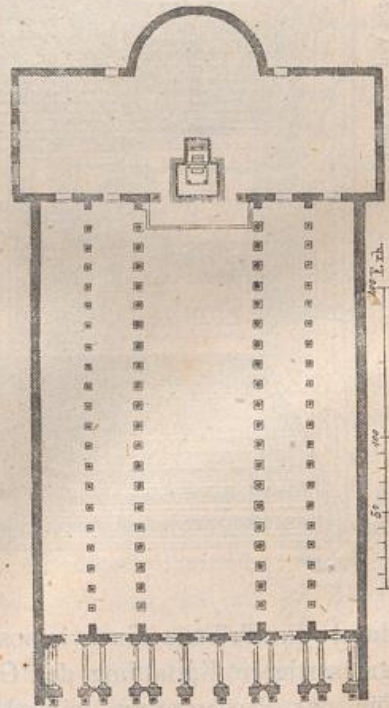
Grundriss von St. Paul bei Rom.
